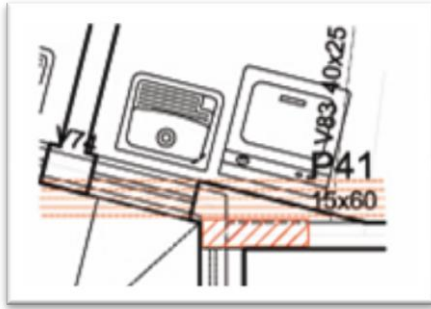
Planta baixa intersecção dutos com pilar.
